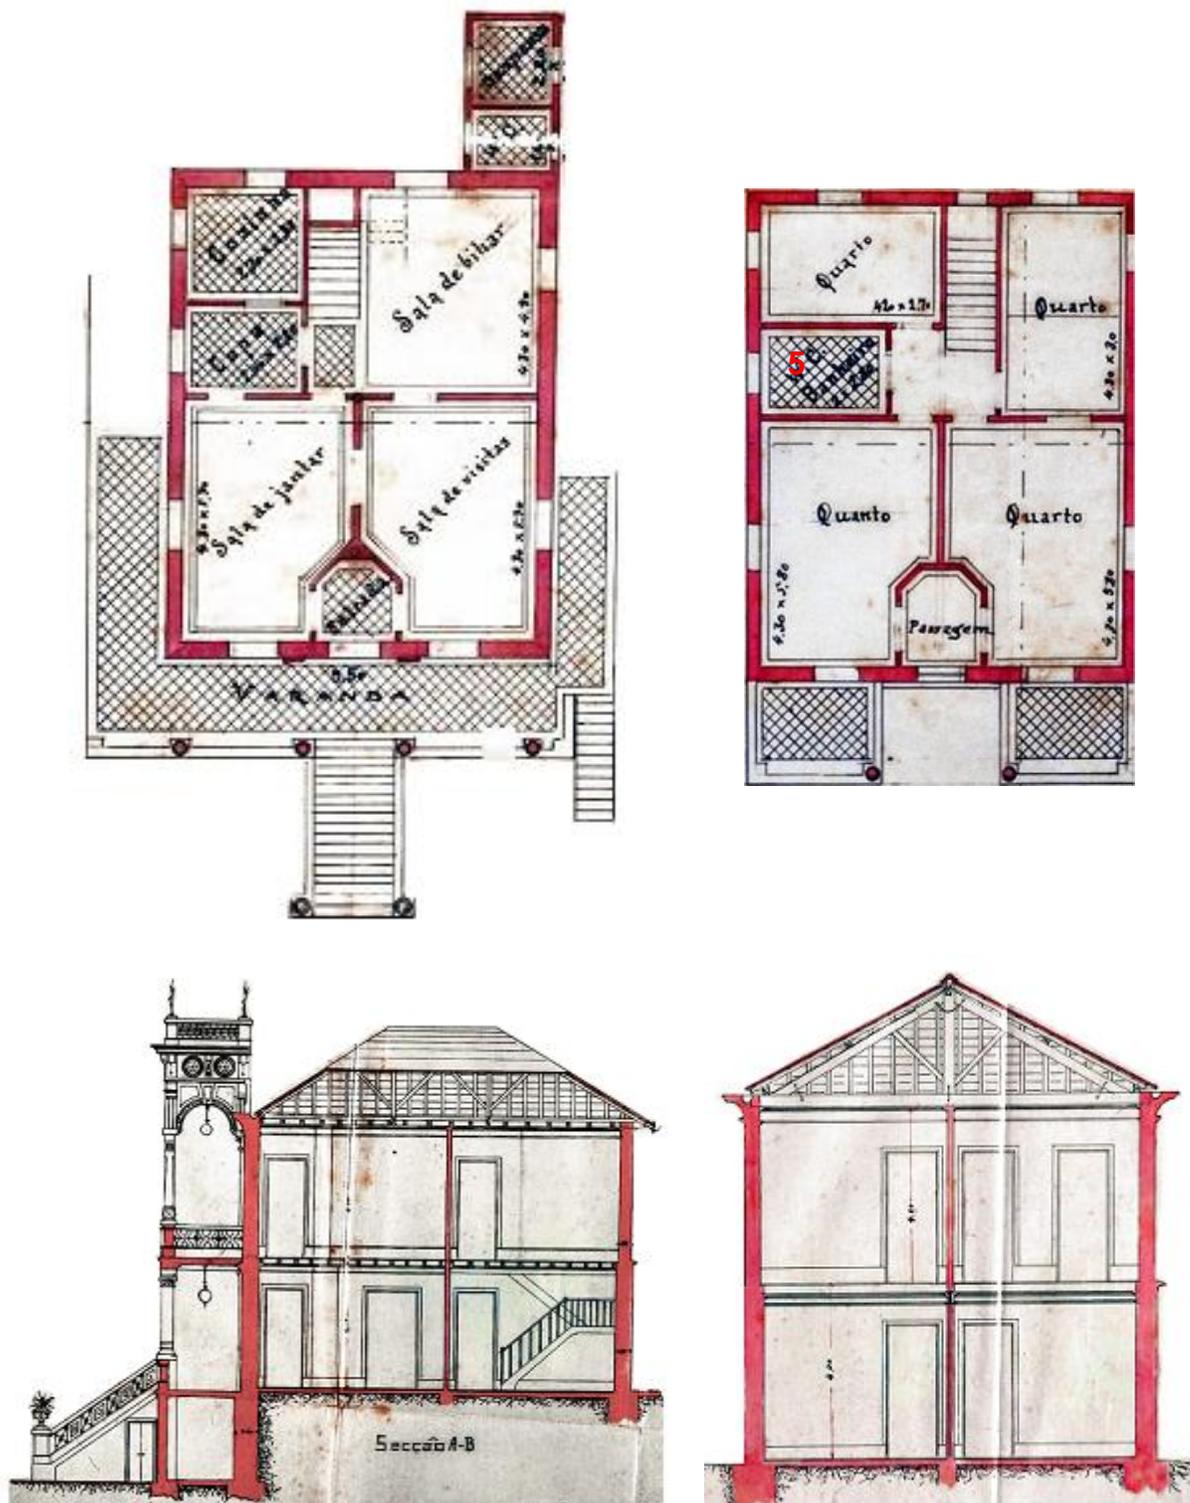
, 194, 195 e 196: Acima, planta baixa do pavimento de acesso e superior. Abaixo, corte longitudinal e transversal da casa.
